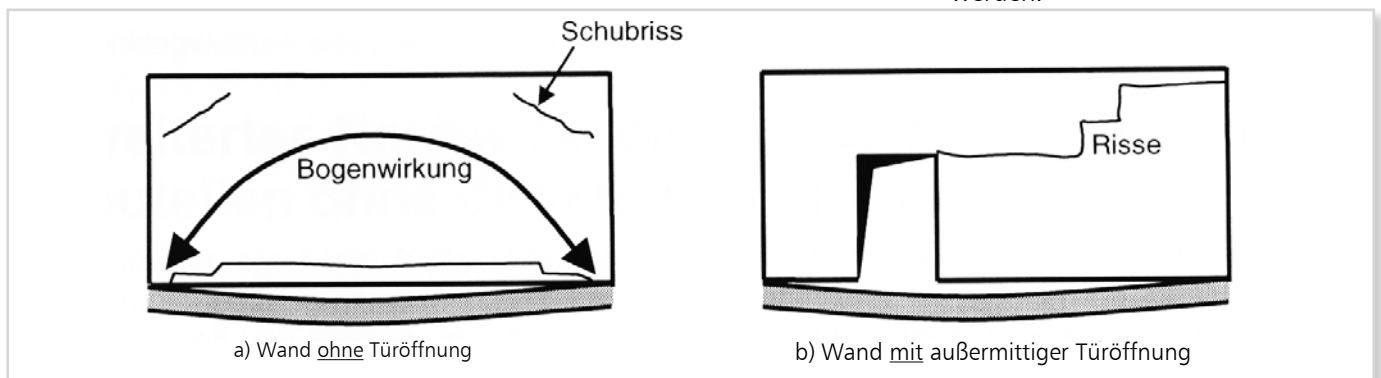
Rissbildung in einer Mauerwerkswand aufgrund großer Deckendurchbiegung
